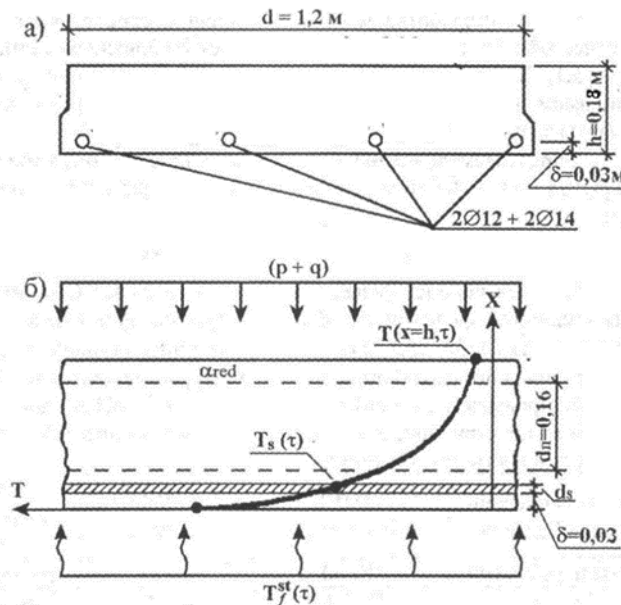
К расчету предела огнестойкости железобетонной, многопустотной плиты перекрытия а) поперечное сечение плиты; б) расчетная схема определения предела огнестойкости плиты.
